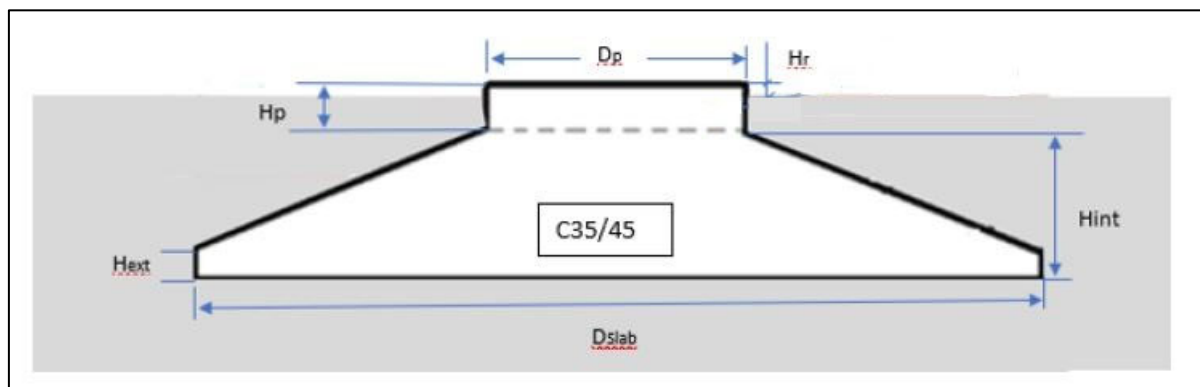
schema plinto da scheda tecnica " Estimated Foundation Design T165-57A SG 6.6-170 "
